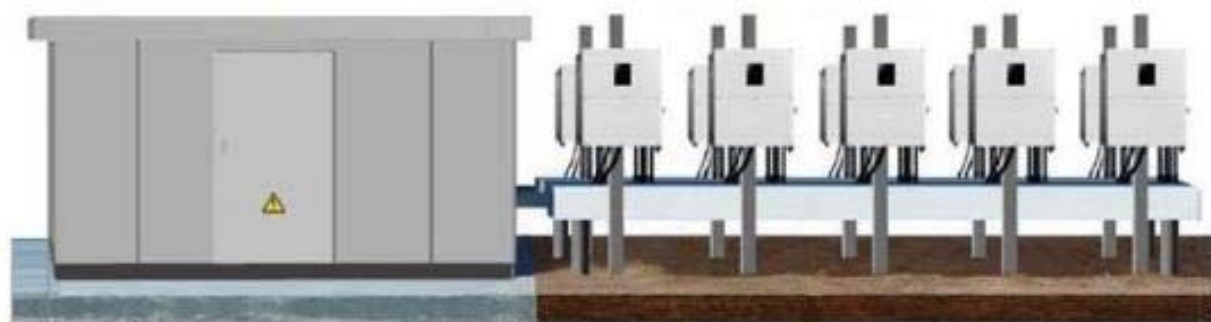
Exemples d'onduleurs installés à l'extérieur et transformateur dans un poste béton
